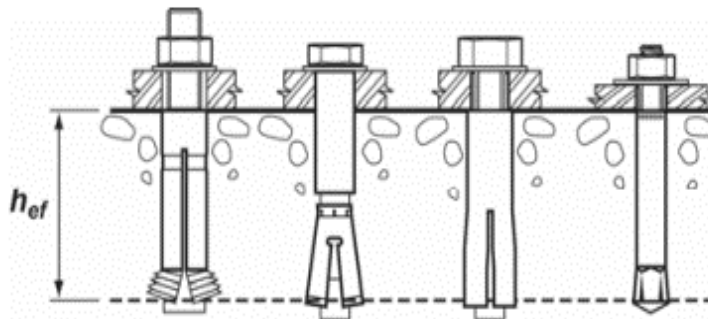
Anclajes post-instalados después de la colocación del concreto.
